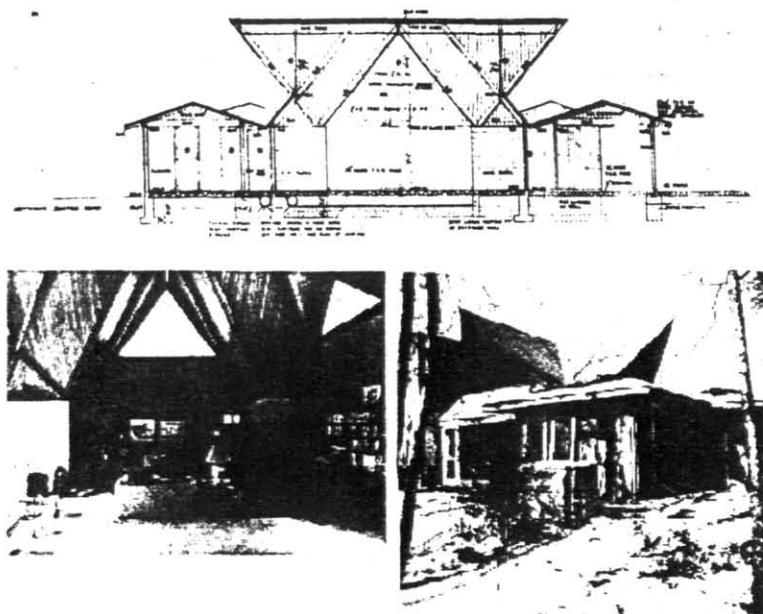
KAHN, Louis I., Clever House, Sherry Hill, New Jersey, 1957-62. Sección y vistas de exterior e interior.
